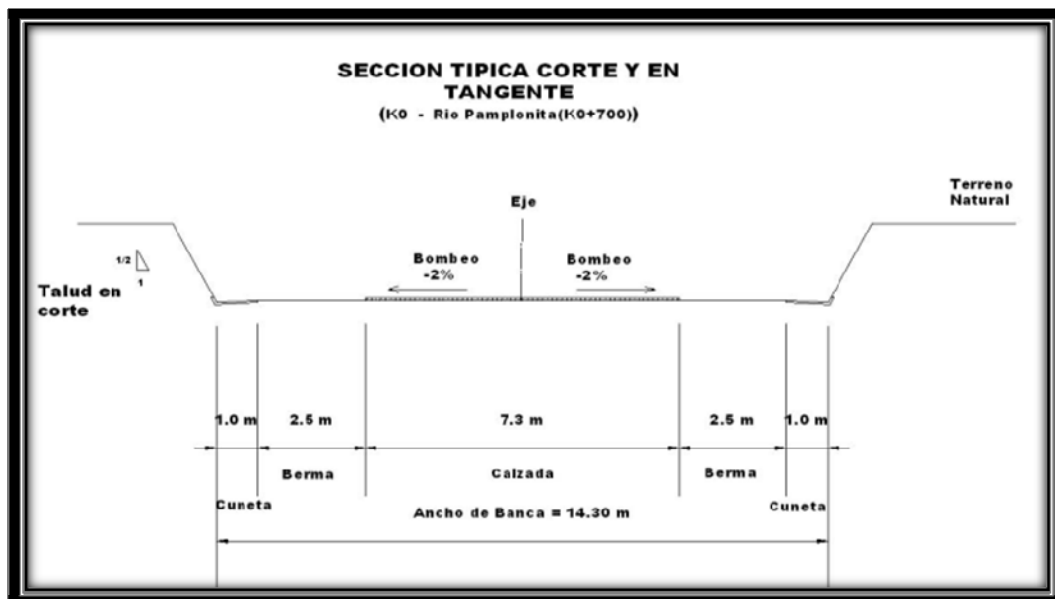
Sección Transversal de la Vía en Corte, Fuente: Elaboración Propia
